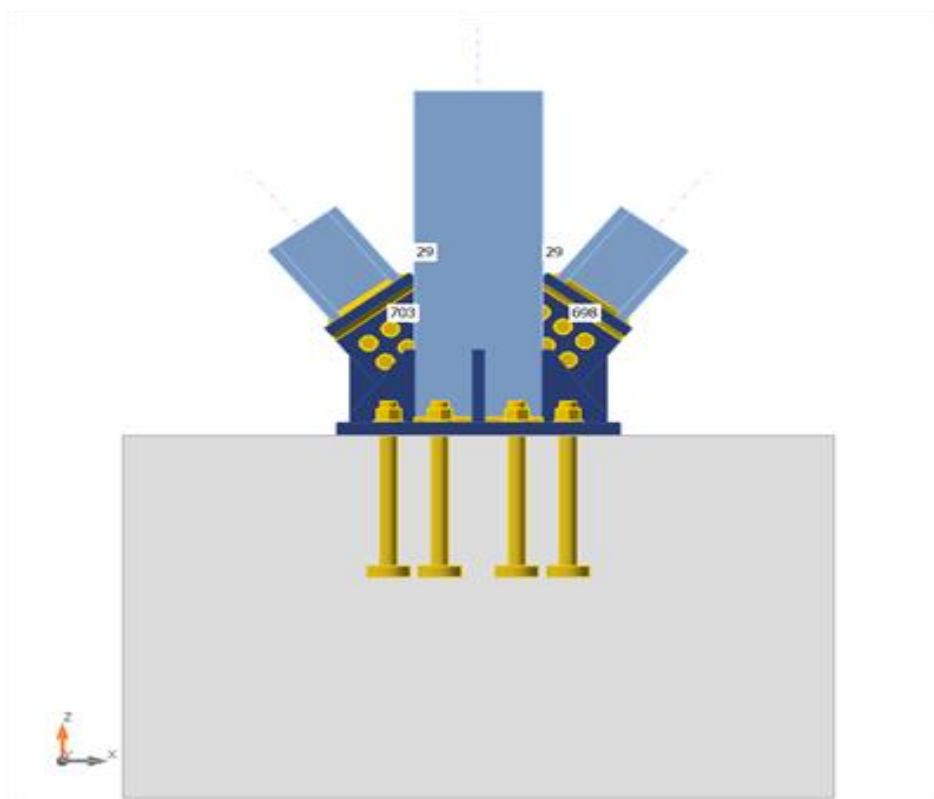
Vue d'assemblage pied de poteau HEB450 – contreventement.
